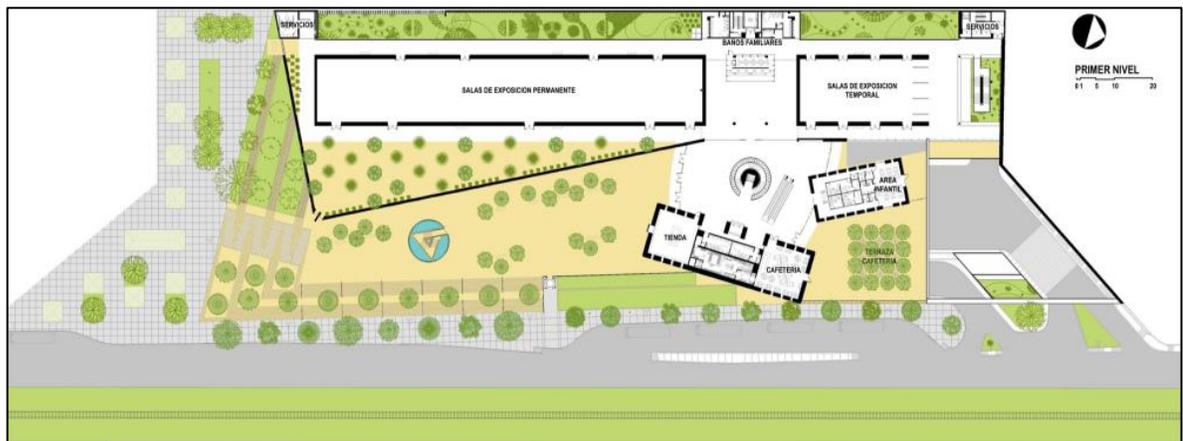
Planta arquitectónica del primer nivel del Gran Museo del Mundo Maya [Plano].
